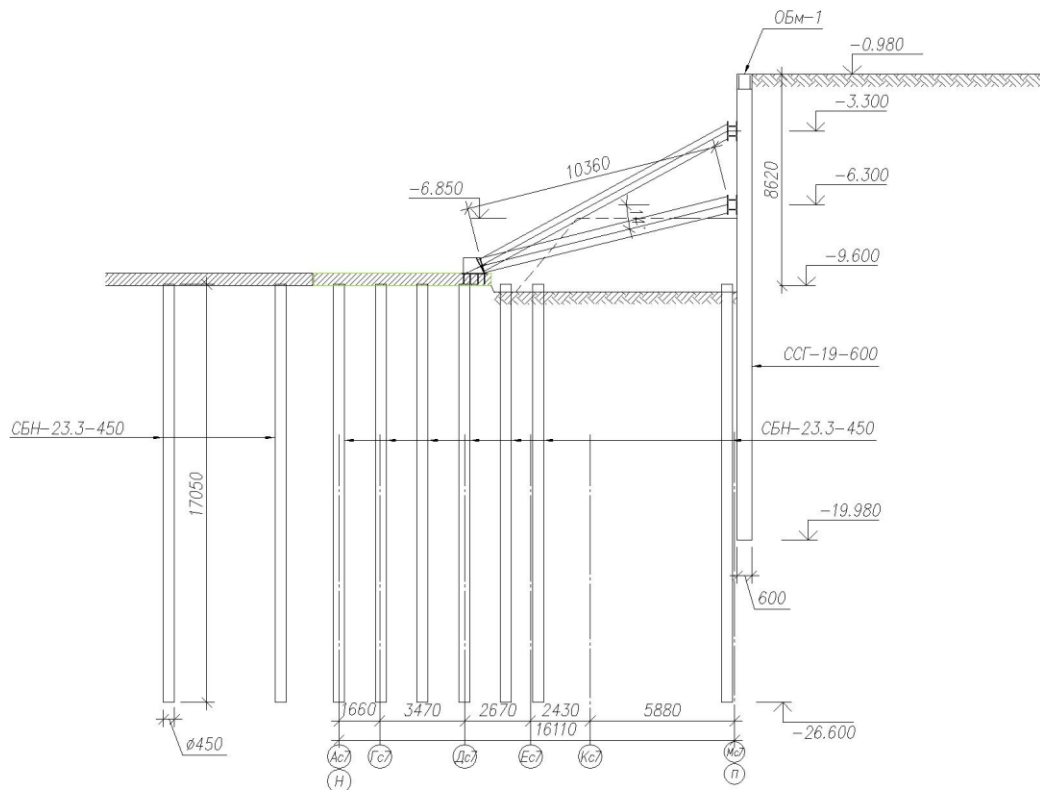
Третий этап, локальная экскавация грунтовой бермы, монтаж подкосов нижнего яруса.
